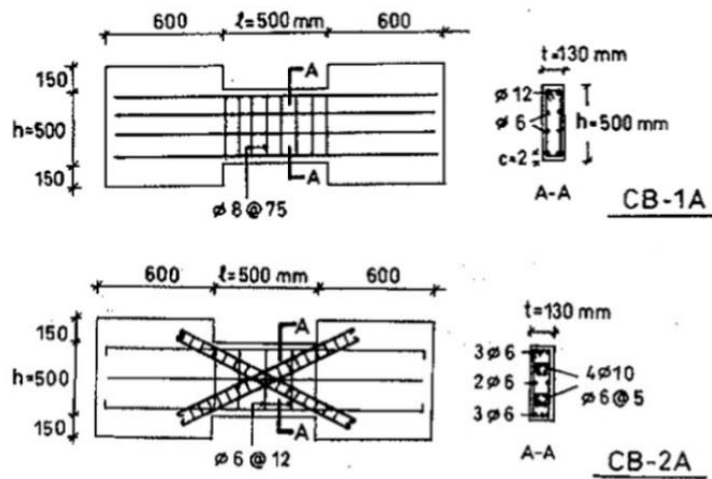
Vigas de acople con distribución de armadura convencional (CB-1A) y con armadura diagonal (CB-2A) [12].
